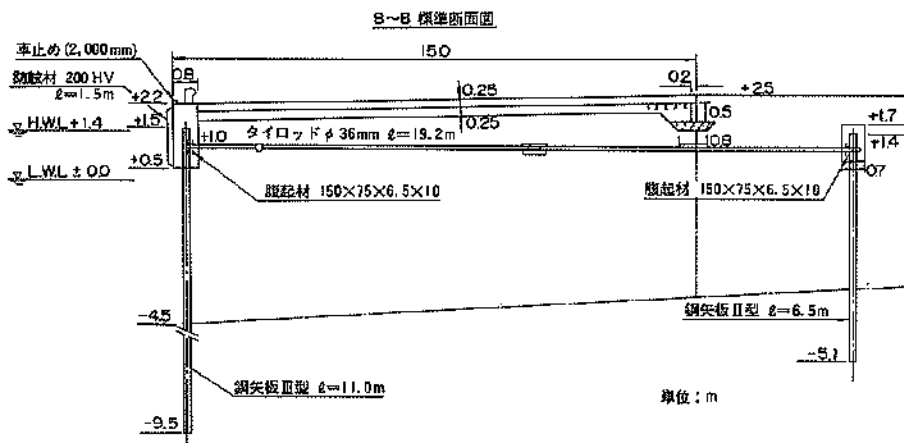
標準断面図 (③中央埠頭-4.5m 岸壁 B-B断面)
